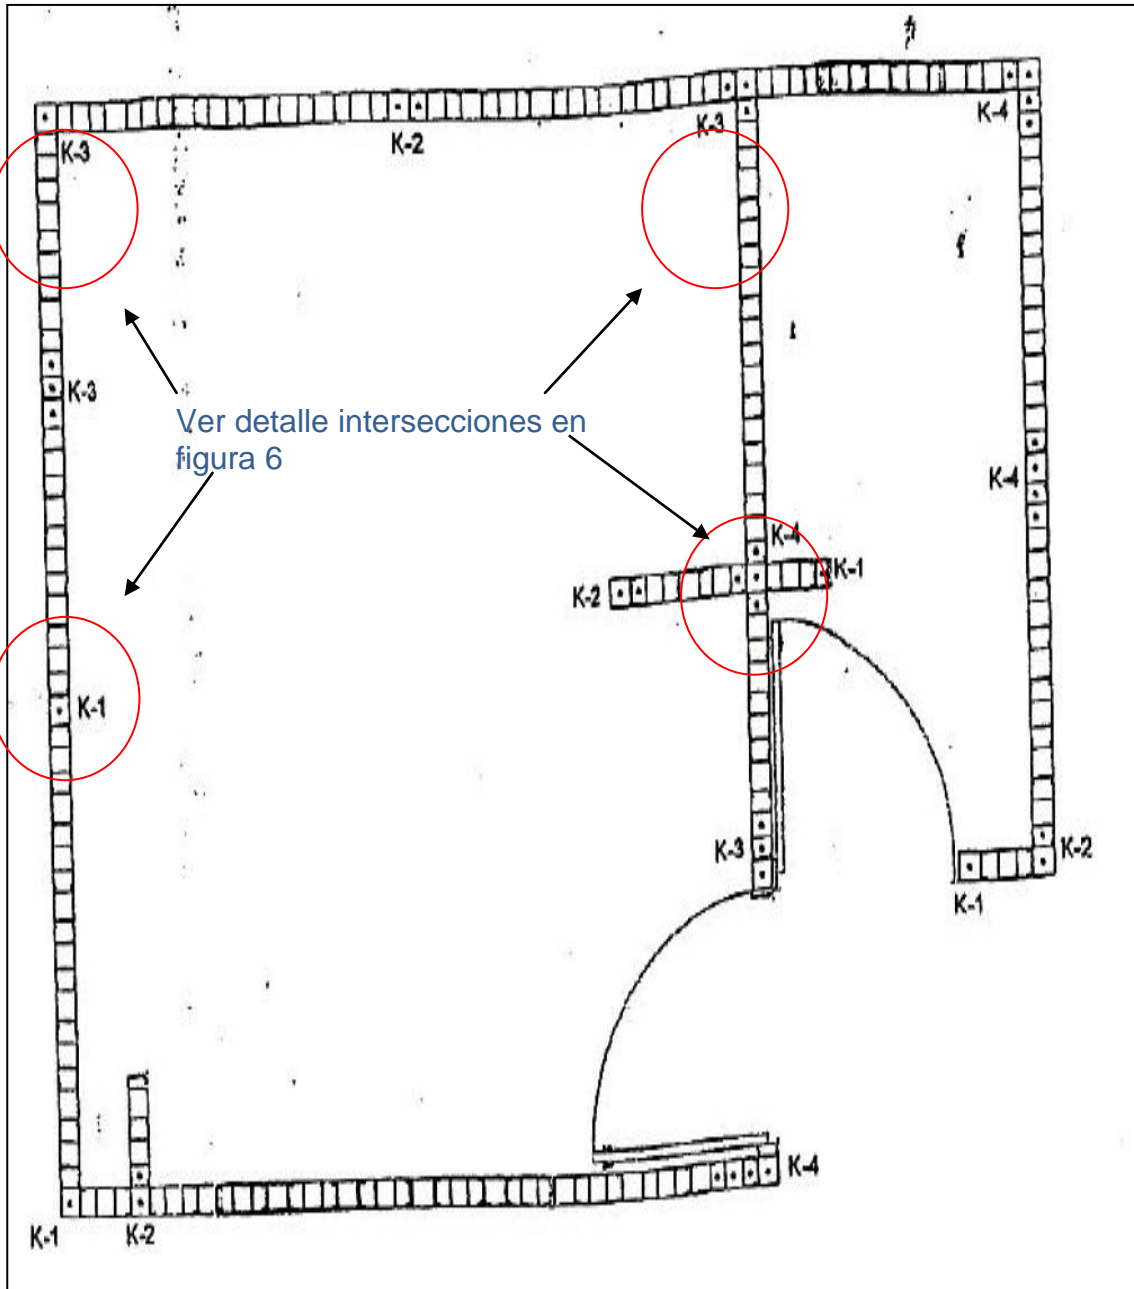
Tipos de refuerzo vertical con 1, 2,3 y 4 varillas para K-1, K-2, K, 3 y K-4 respectivamente
